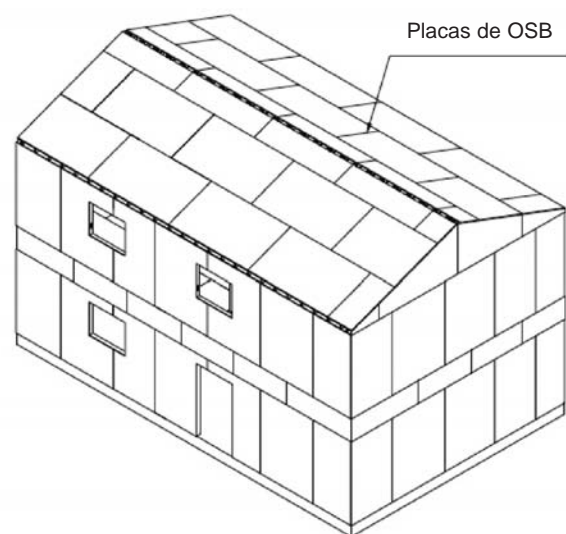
Colocación de las placas de OSB en la estructura.
